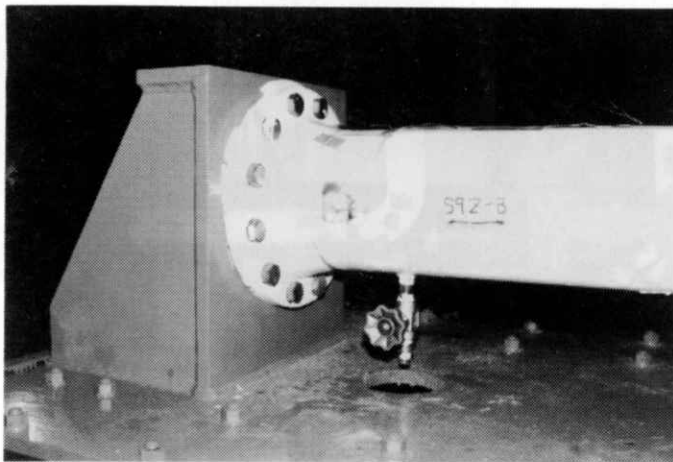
下部アンカー (振動板No.4上、8 B 管)
